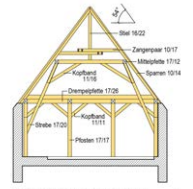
Haupttragwerk Zelt/Turmdach, M 1:100
